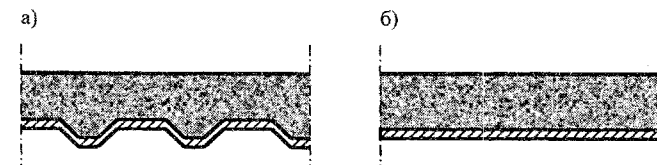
Поперечні перерізи сталезалізобетонних плит:
